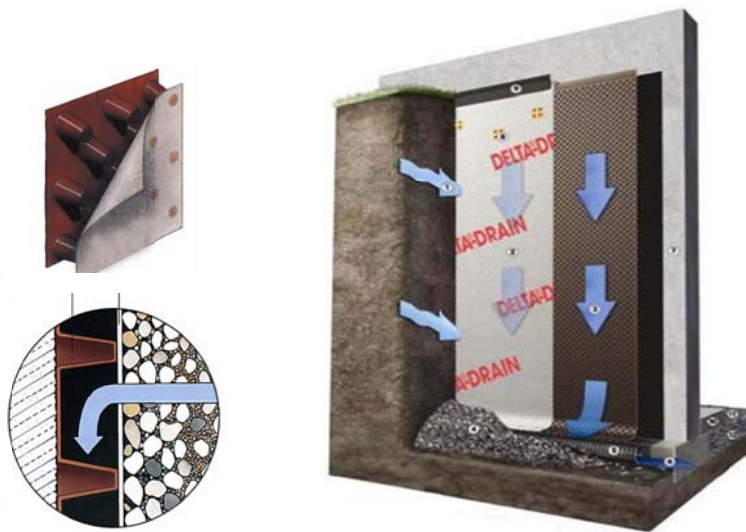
Pormenor (esquerda) e exemplo de aplicação de uma manta drenante (direita) [45].
